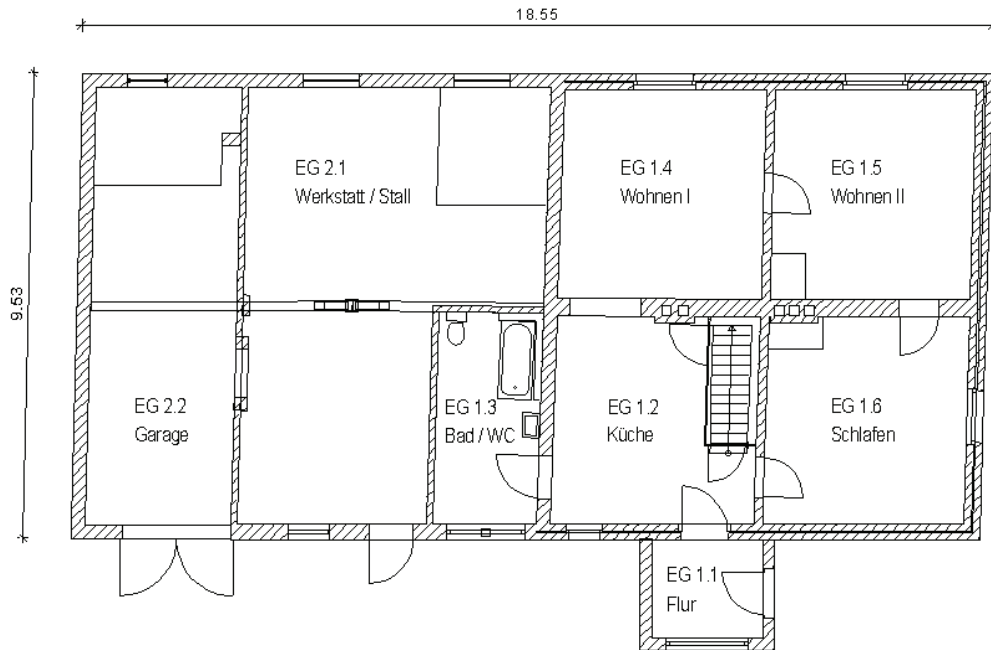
Erdgeschoss, schematischer Grundriss
